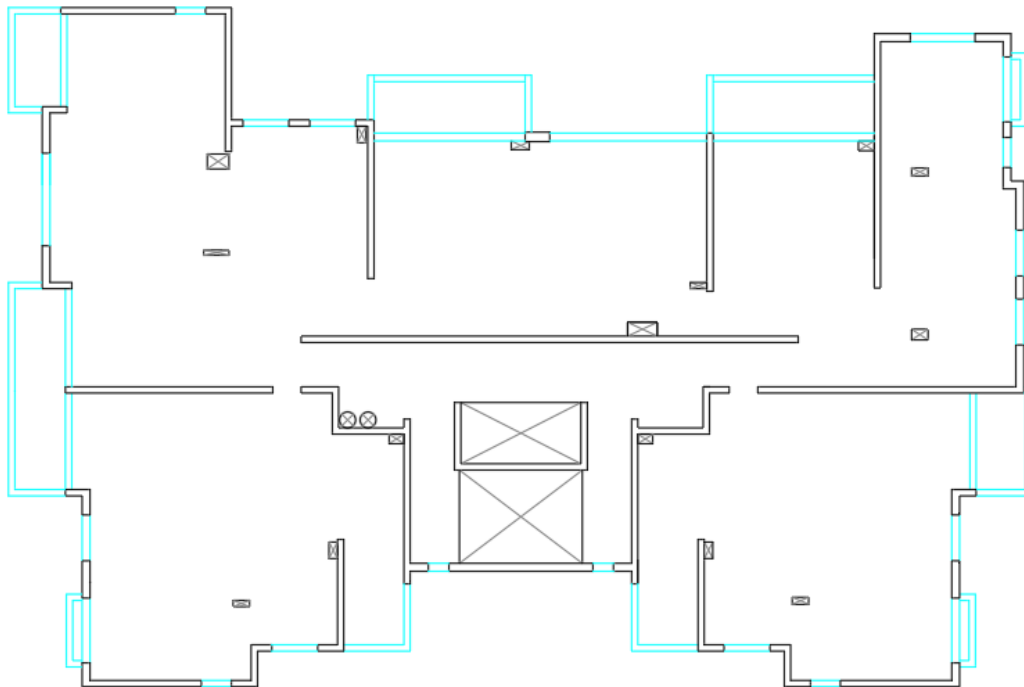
Adaptación de plano estructural de plantas de los pisos 7 al 15.
